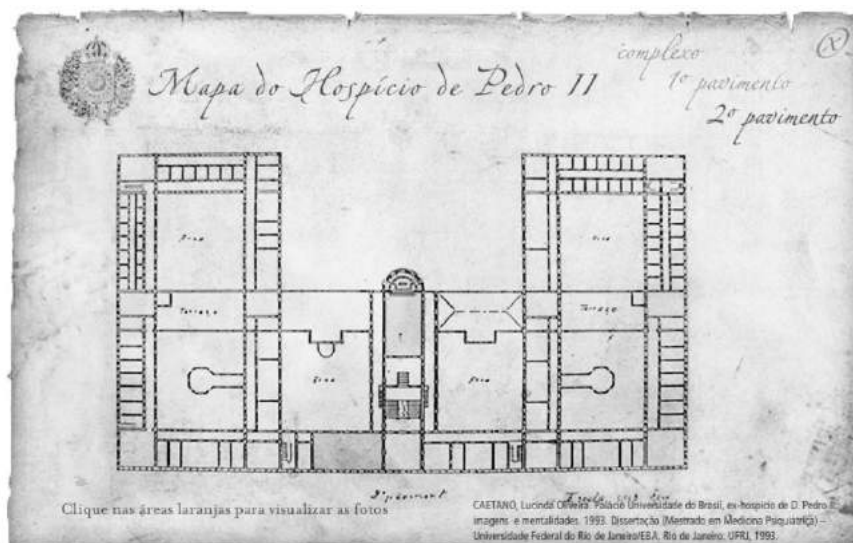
Planta do 2º Pavimento. Fonte: ARQUIVO CCMS
